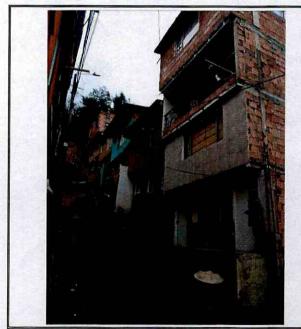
Vista frontal vivienda emplazada en predio 2. Tomada de DI-10849 – 22/05/2017
